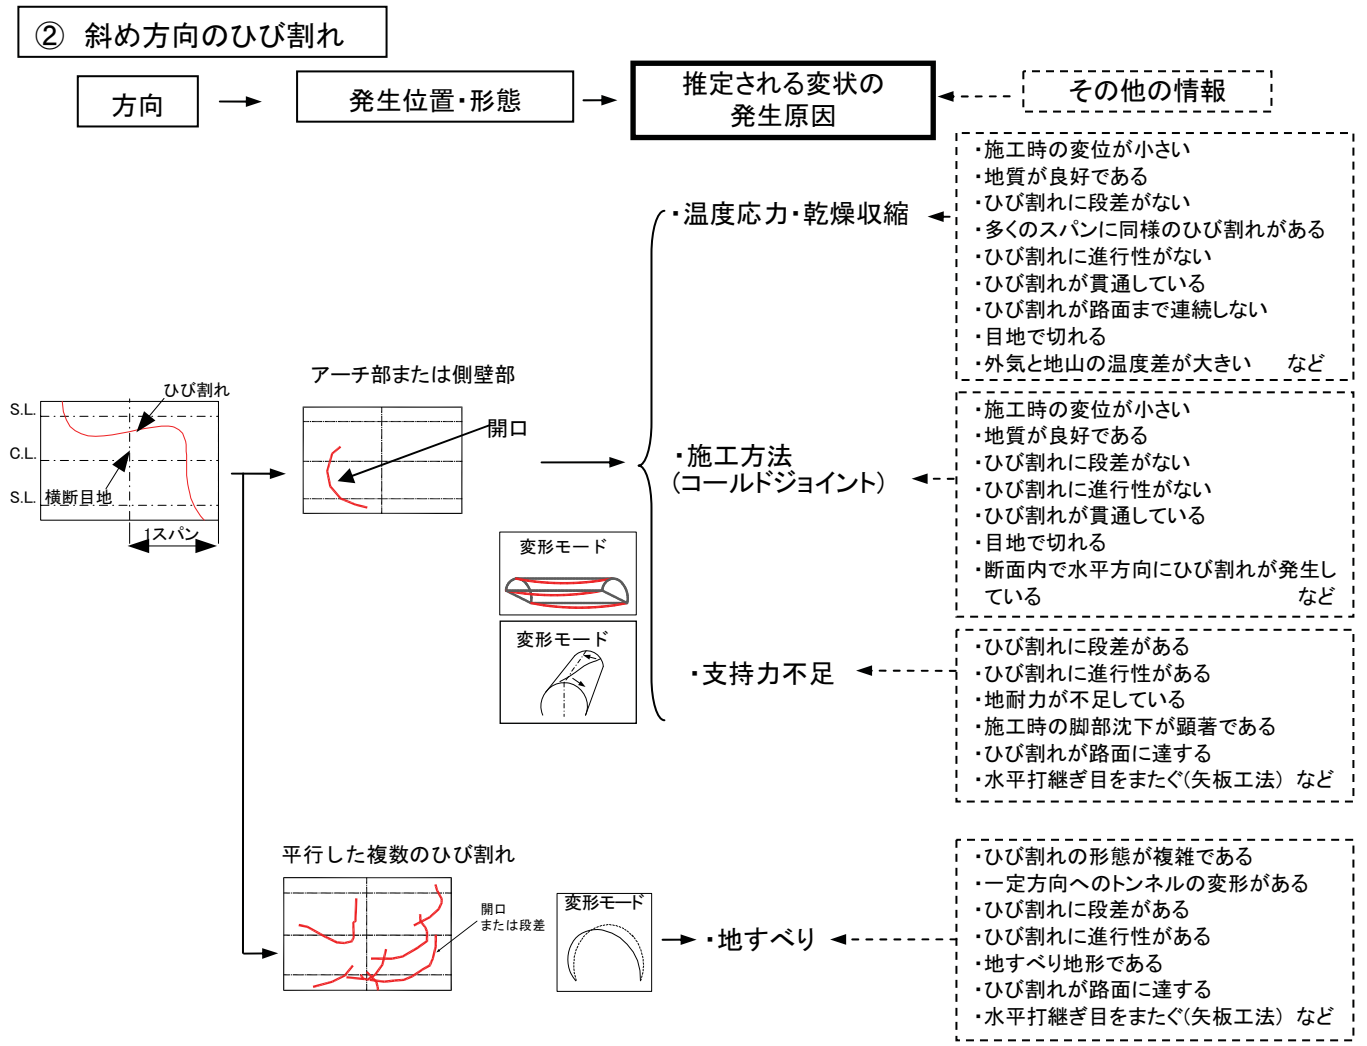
斜め方向のひび割れに対する変状原因推定のためのチャート図
